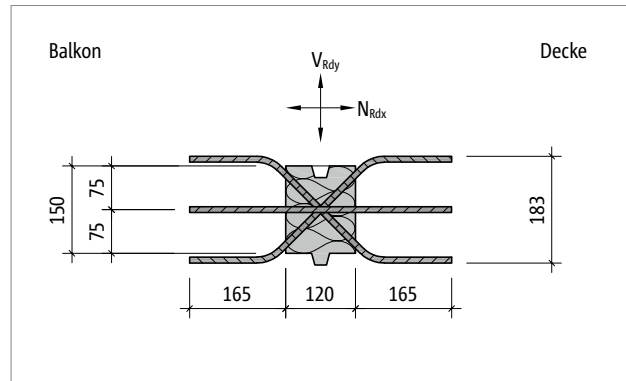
Schöck Isokorb® XT Typ HP-VV1-NN1: Produktgrundriss
